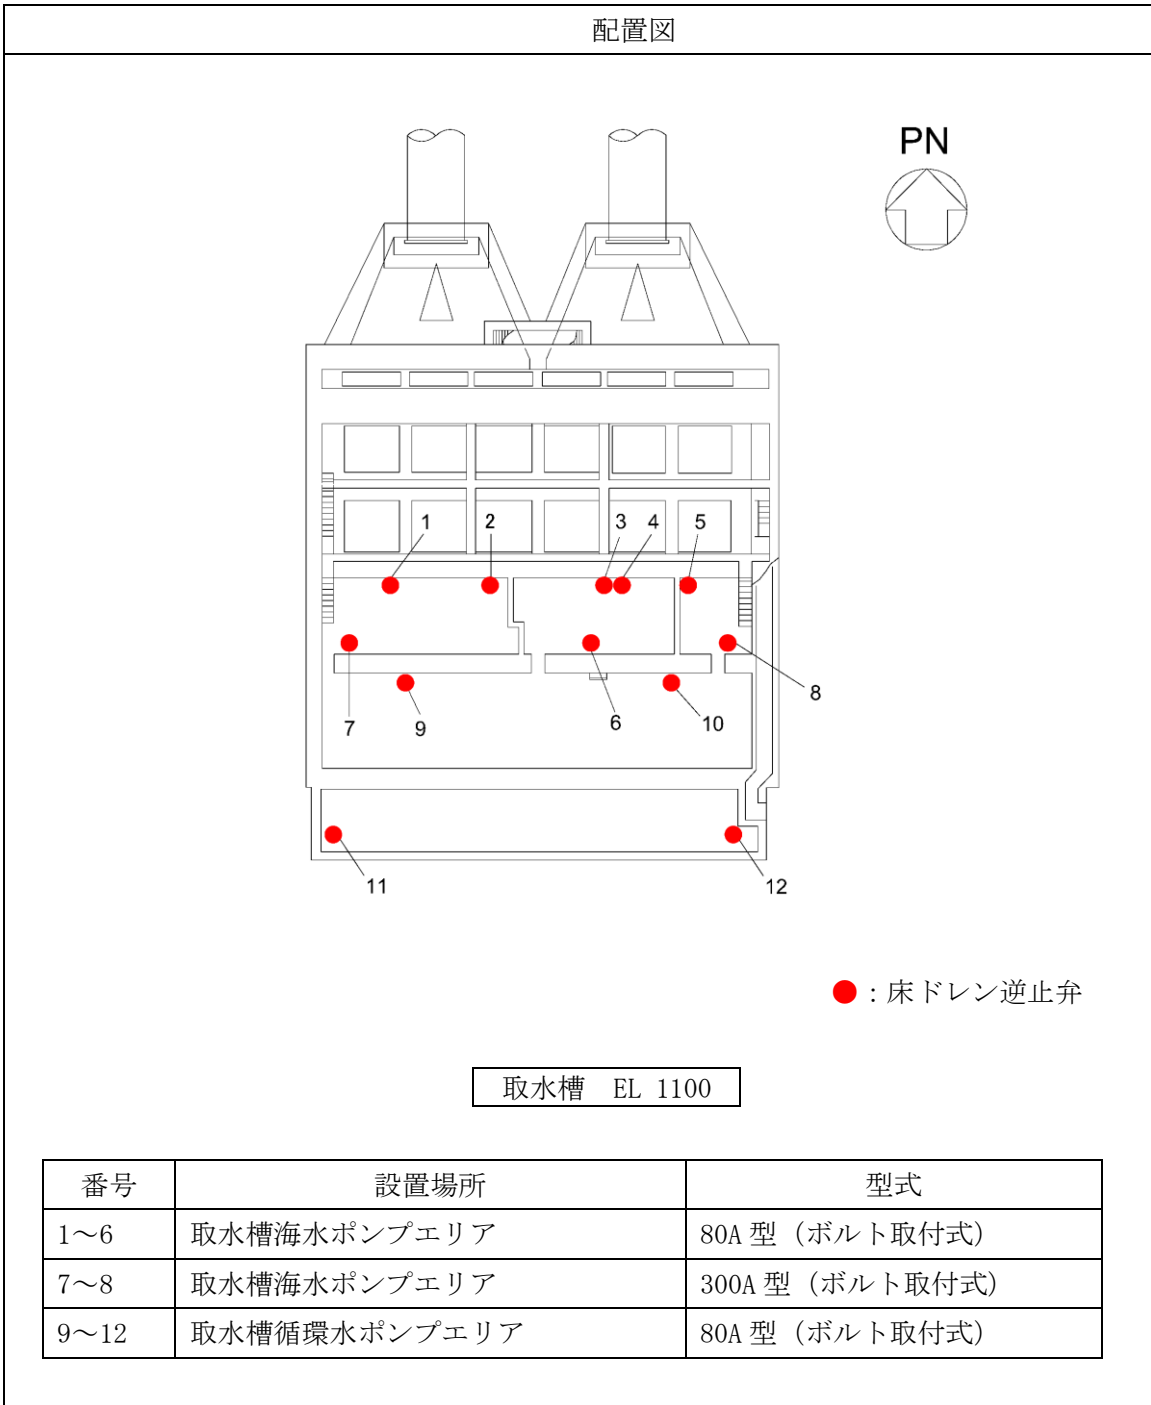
床ドレン逆止弁の設置位置図 (3/3)
